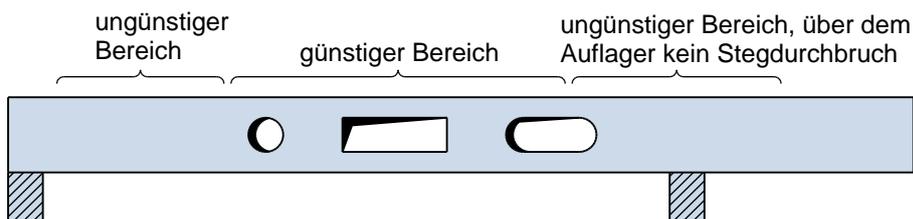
Stahlbetonbalken mit Öffnungen (Durchbrüchen) im Steg
